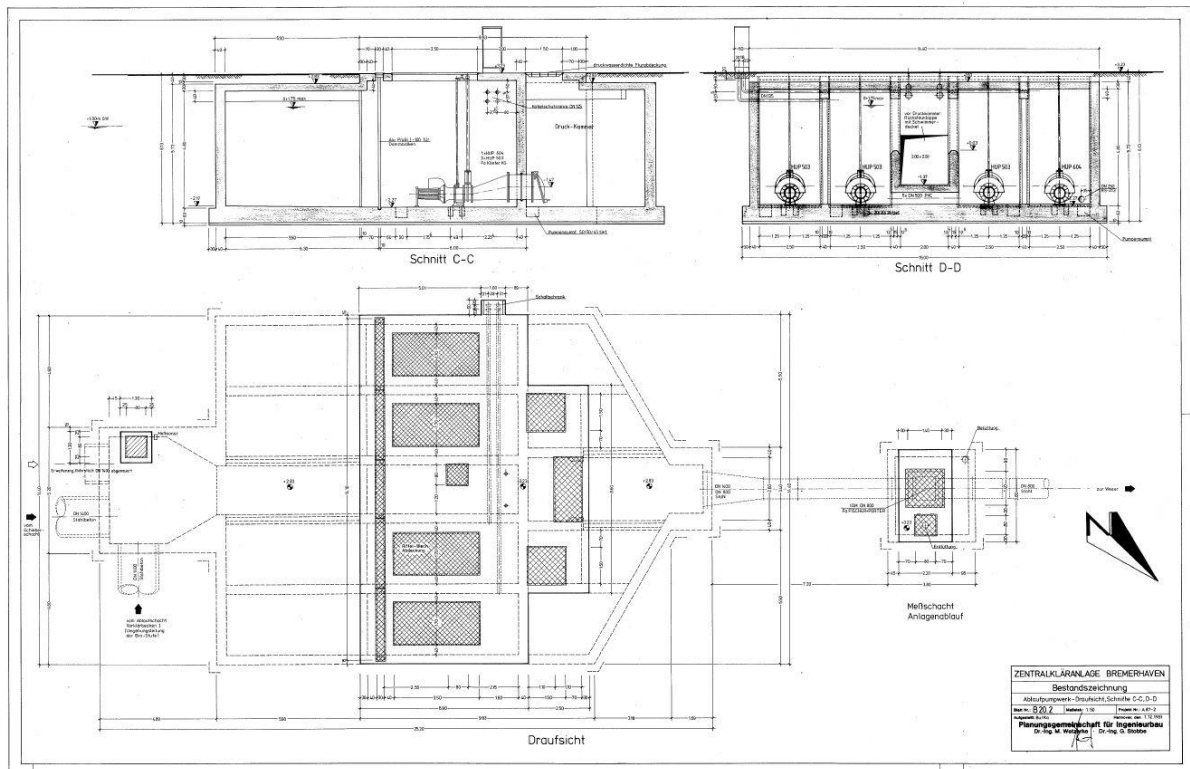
Ablaufpumpwerk der ZKA – Draufsicht und Schnitt
